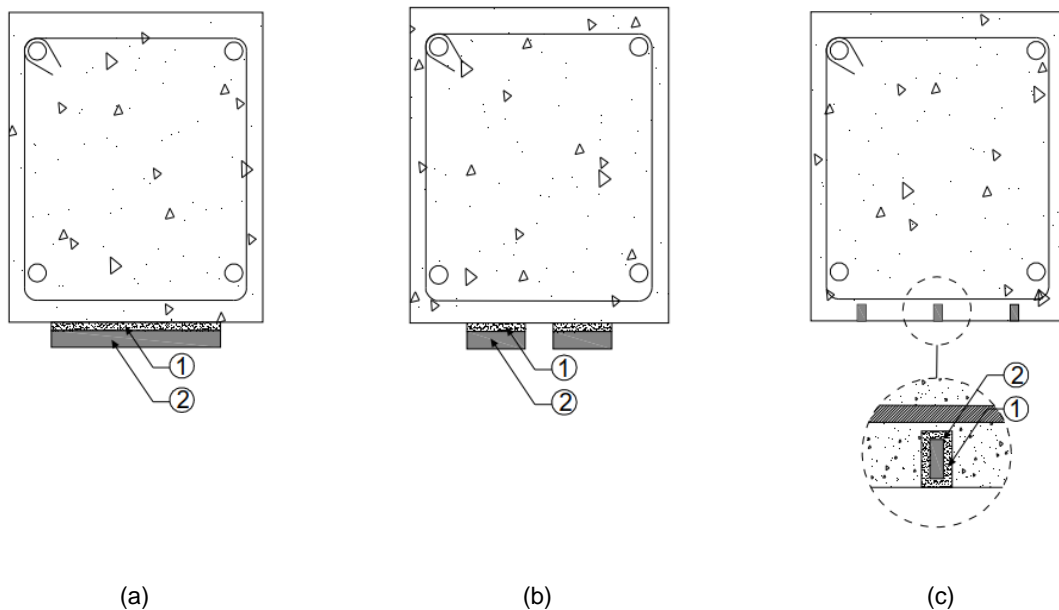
Reforço de vigas e lajes à flexão por colagem de armaduras de FRP com adesivo de ligação e de uma única lâmina (a), de mais do que uma única lâmina (b) e introdução de lâminas em ranhuras (c) – adaptado de Sousa (2008)
